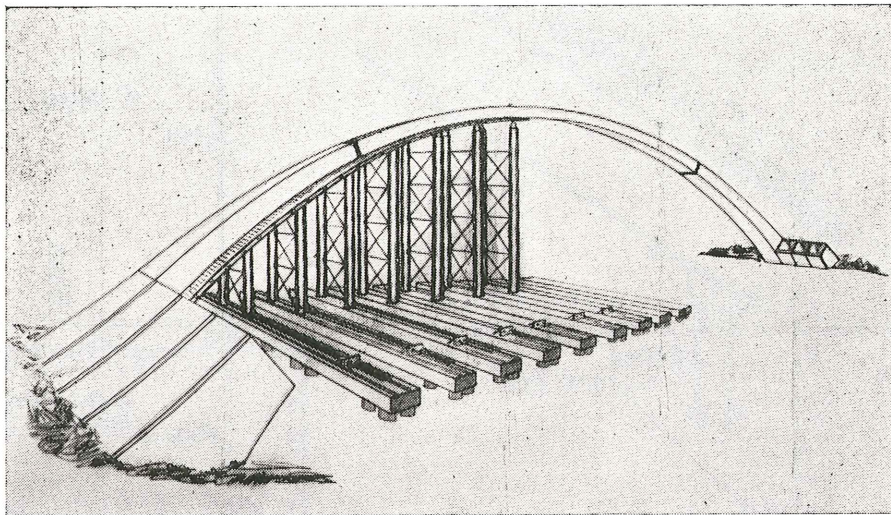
Una de las dos secciones móviles de la cimbra.
